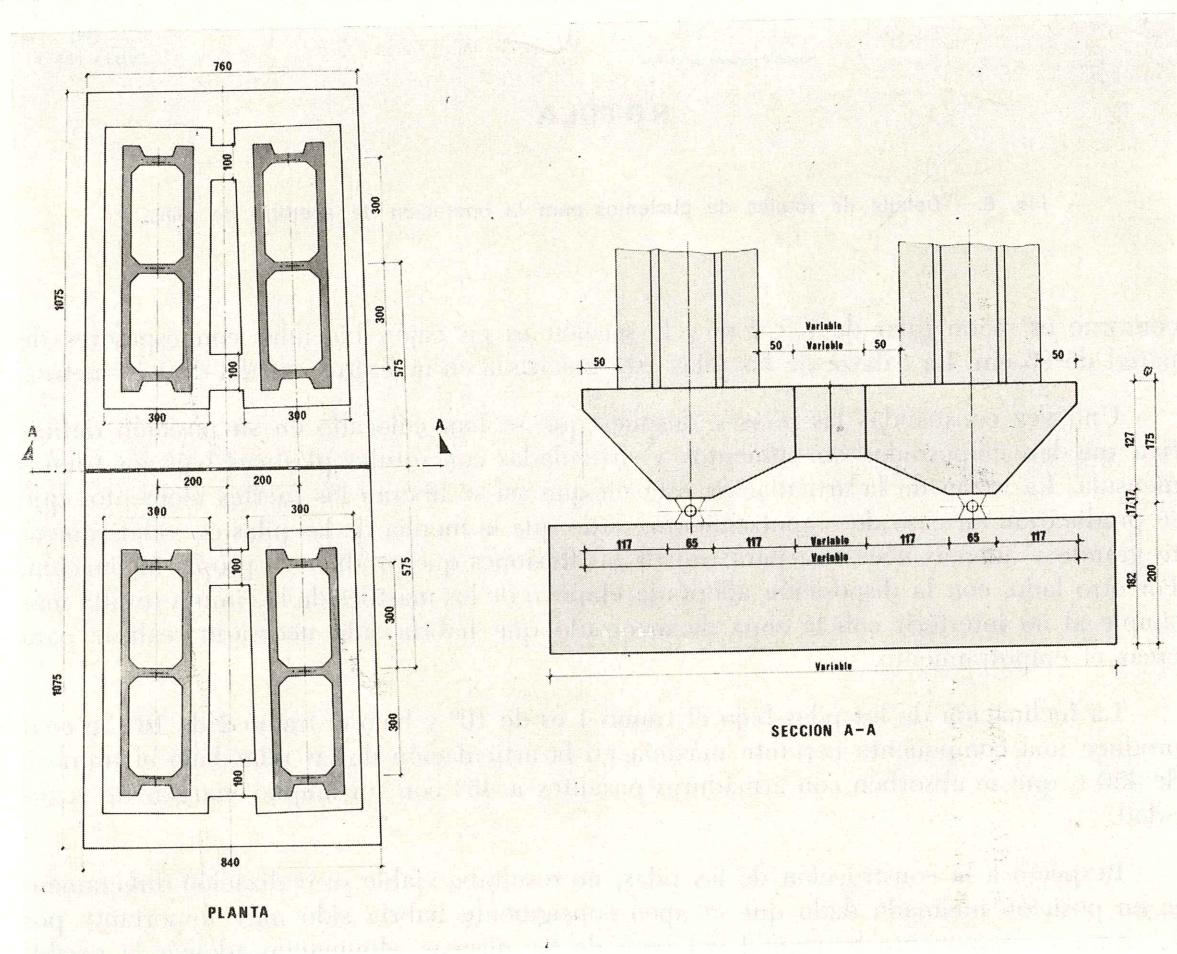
Geometría de cimientos y arranques de pilas durante la construcción y antes de la apertura.
